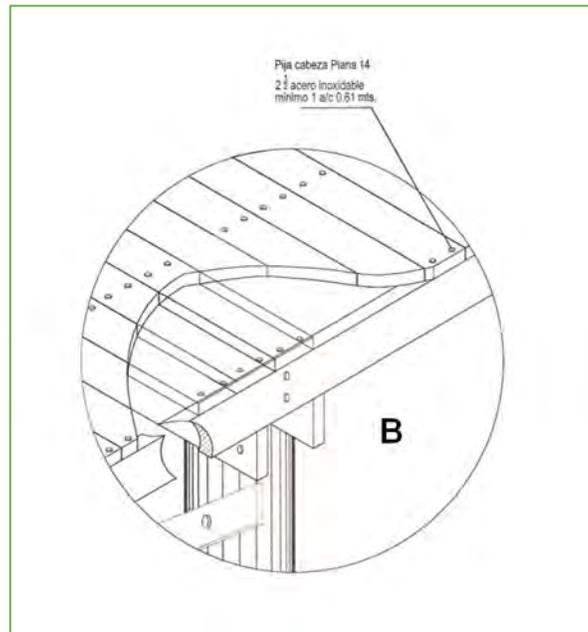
Indica el modelo base constructivo para el muelle, en las uniones de los tablonces de la cubierta y pilotes para soportes.
